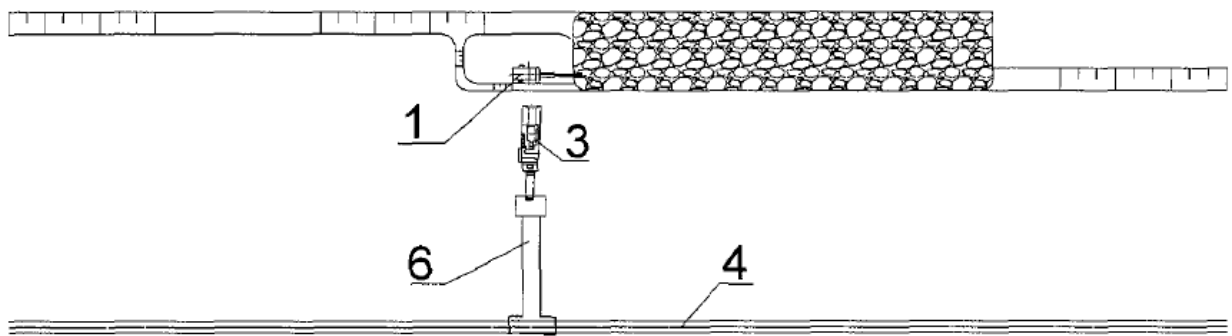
Схема розробки гірських порід з торцевим розташуванням (МДК) та збільшеною шириною робочого майданчика при конвеєрному транспорті: 1 – екскаватор (або навантажувач); 3 – мобільний дробильний агрегат (комплекс); 4 - конвеєр стрічковий передавальний; 6 - конвеєр пересувний стрічковий (або мобільний телескопічний)
